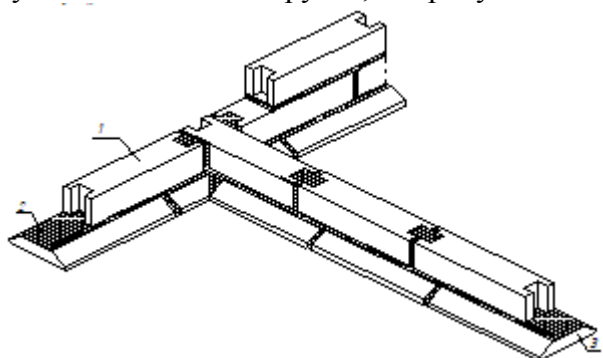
Вариант сборного ленточного фундамента: 1-фундаментный блок, ФБС; 2-цементно-песчаный раствор; 3-фундаментная подушка, ФЛ.
